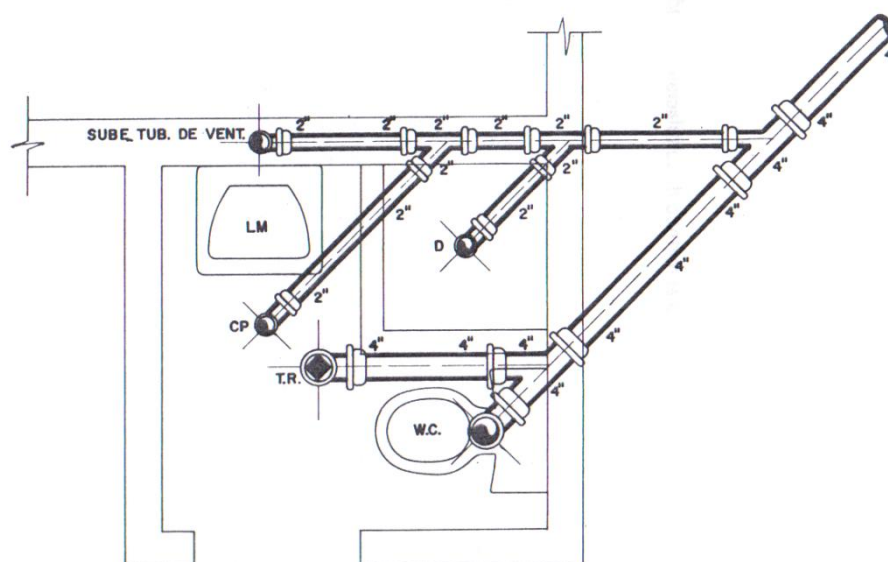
Ventilación Húmeda para edificaciones de uso residencial - Planta
